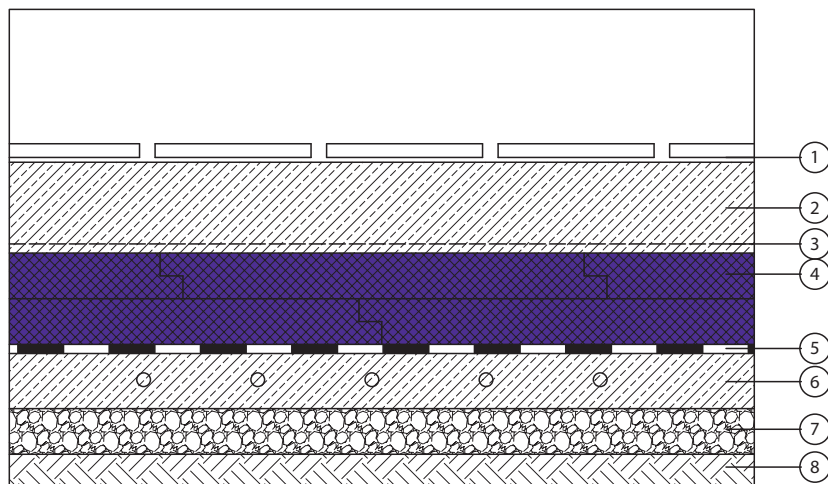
Схема расположения СОУ в железобетонном слое под теплоизоляцией STYROFOAM GEO
